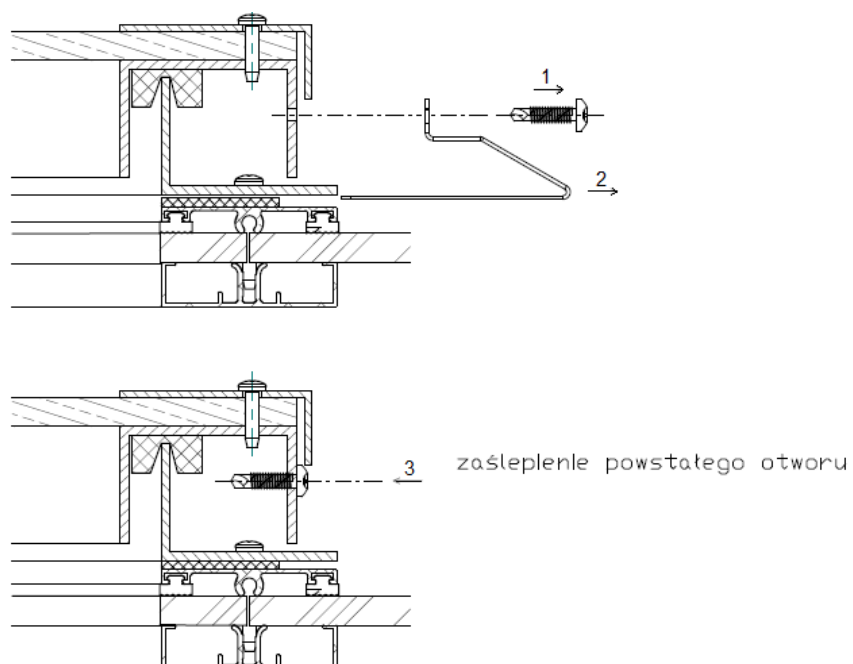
Przygotowana do montażu klapa 2-skrzydłowa (dostarczona w całości na budowę)
